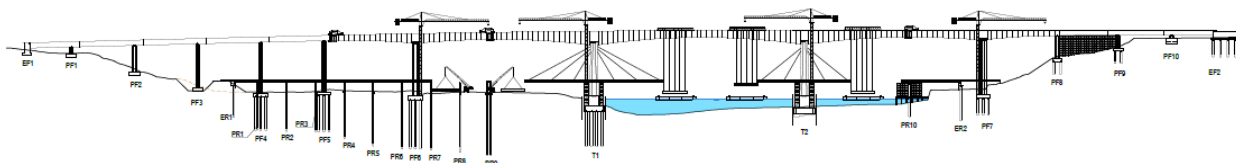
Faseamento construtivo – Etapa 5 de 6
